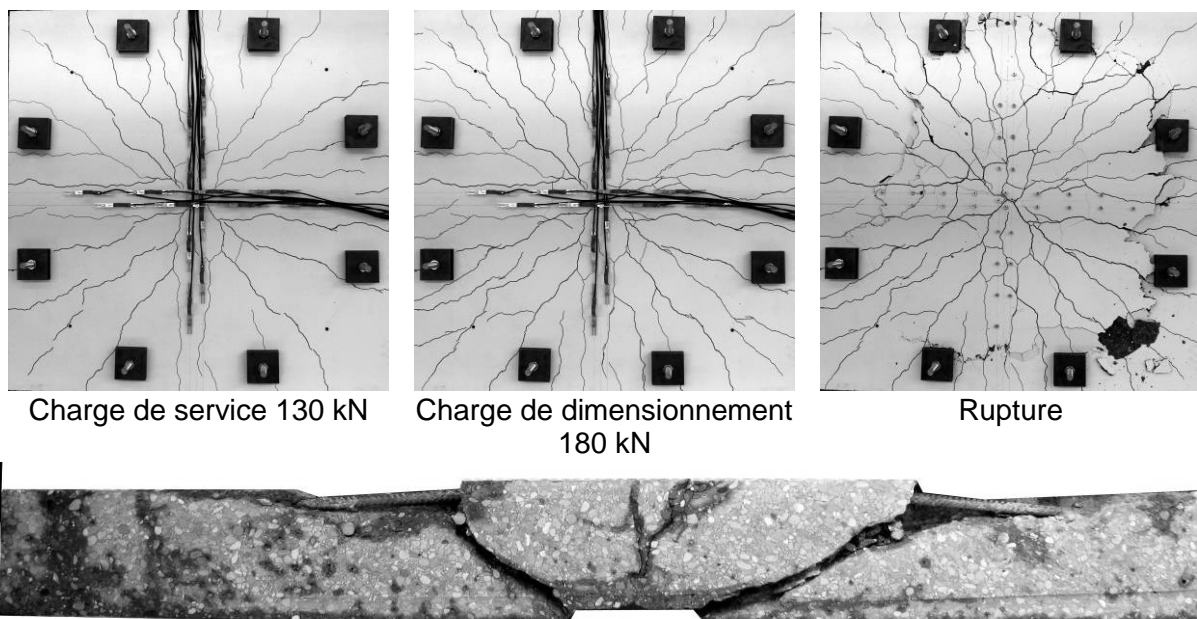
Fissuration à plusieurs niveaux de charge et fissures internes de la dalle B1-01.
